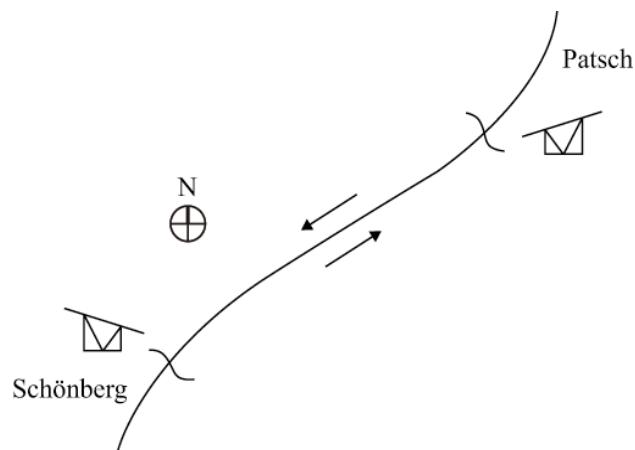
Schema zur Grundrisskrümmung der Brücke und der dadurch auszuführenden, quer-geneigten Hohlkastengeometrie
